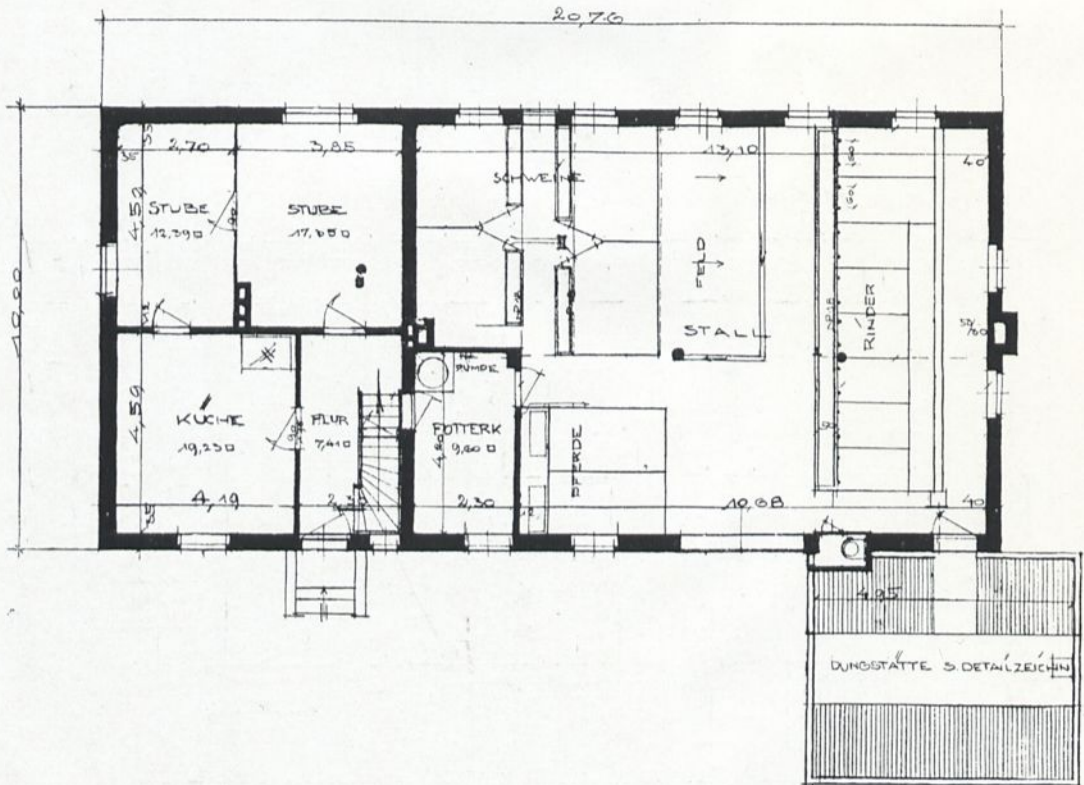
Wohn- und Stallgebäude mit überdachter Düngstätte nach Typ „E 3“ 1929
